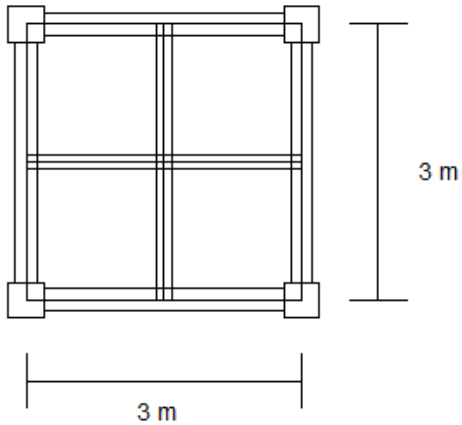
Denah Tampak Lantai 1 (Tipe 3)
